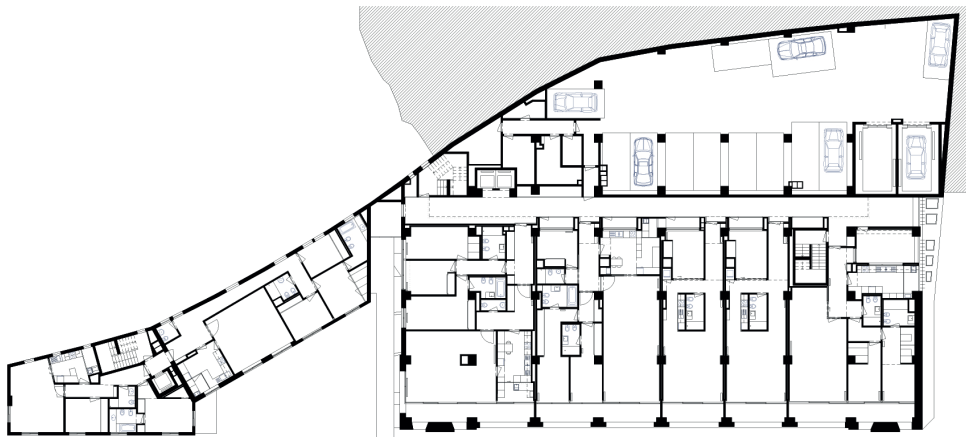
Planta Pisos 1,2 e 3 - Intervenção.
